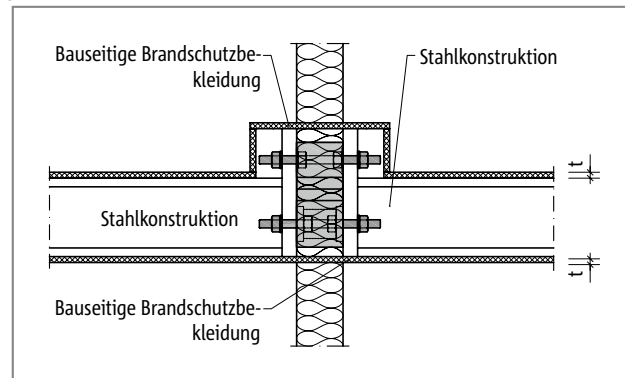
Brandschutz Schöck Isokorb® T Typ S: Bauseitige Brandschutzbekleidung bei überstehenden Stirnplatten; Schnitt
